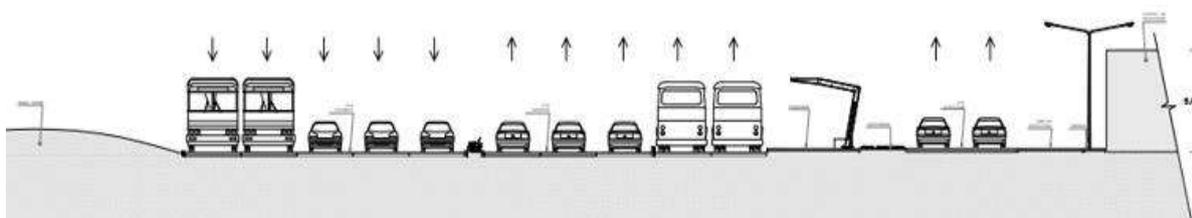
Sección Vial de la Carretera Panamericana Sur, SJM.
